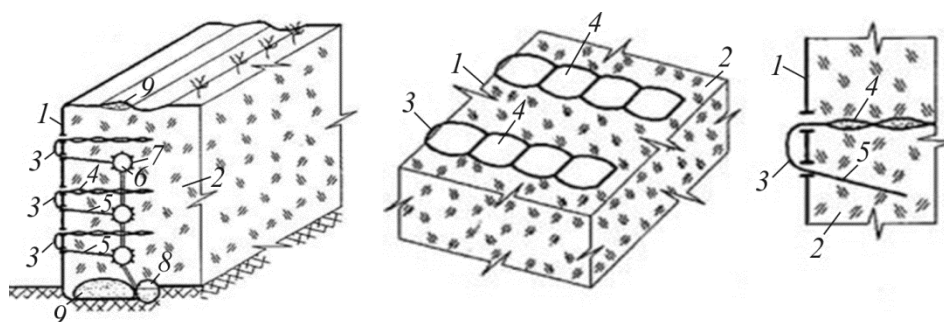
Грунтоармированное подпорное сооружение с единой лицевой стенкой: 1 – лицевая стенка; 2 – насыпной грунт; 3 – гибкие связи; 4 – ленты-оболочки; 5 – гофрированные и плоские армоленты; 6 – оболочка-дрена; 7 – специальные отверстия; 8 – дренажная система; 9 – анкерные блоки
